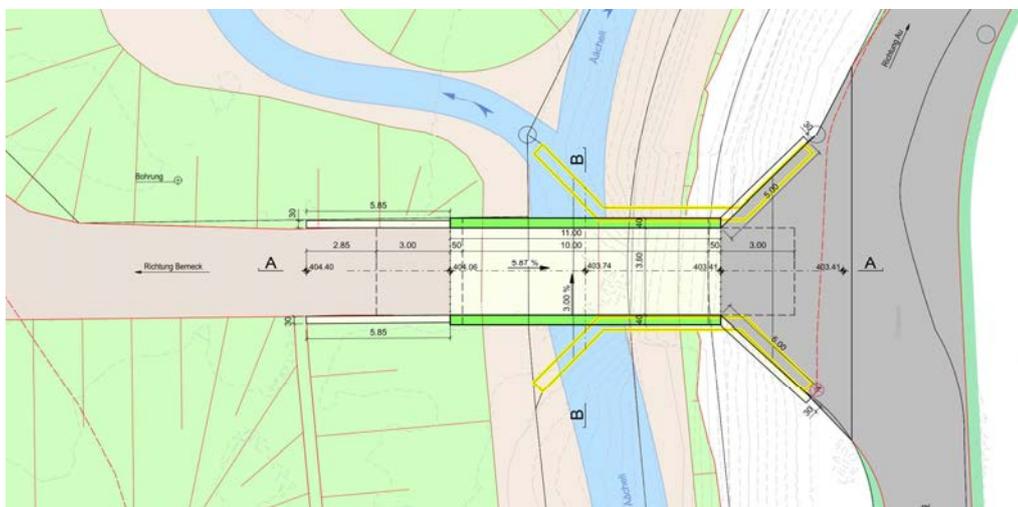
Horizontale Linienführung Brücke Wisenstrasse, Ächeli
